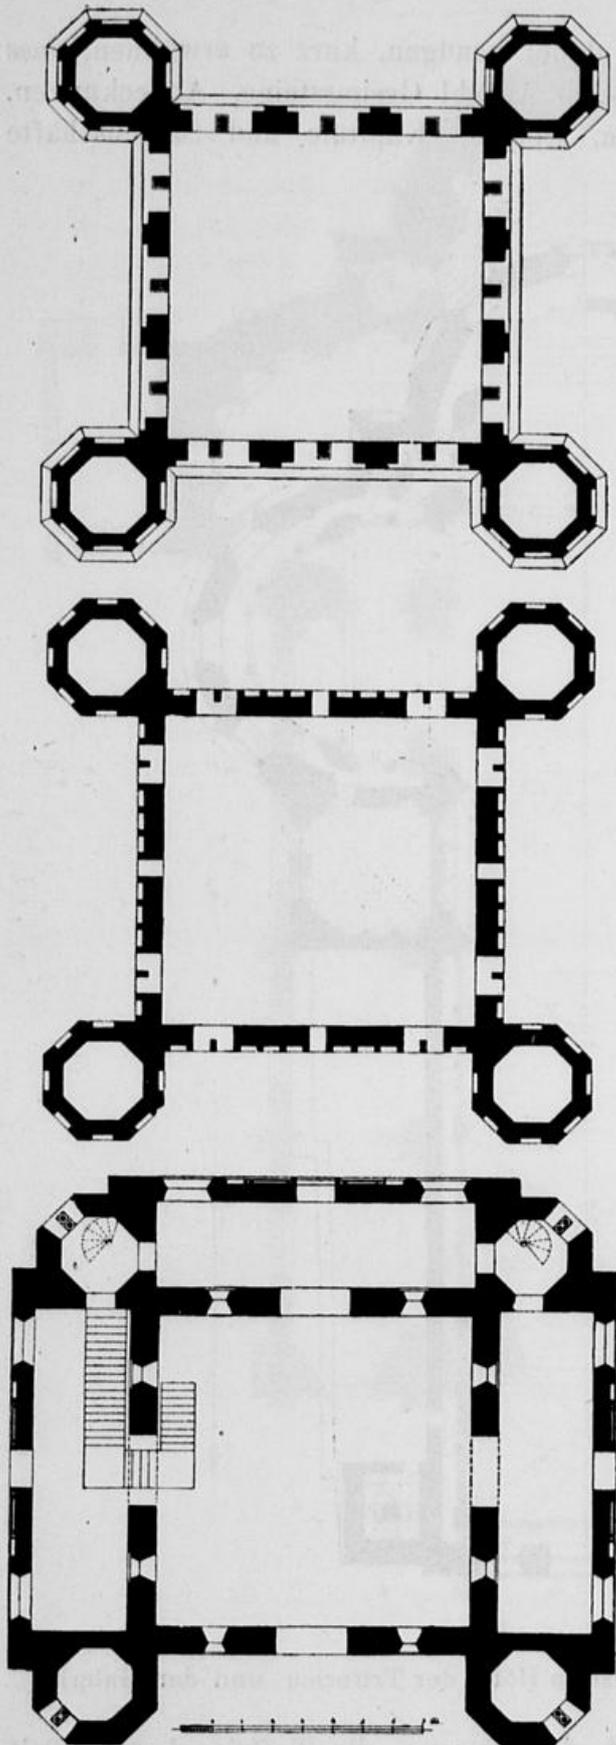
Köln, Gr. St. Martin. Grundrisse des Vierungsturmes.
